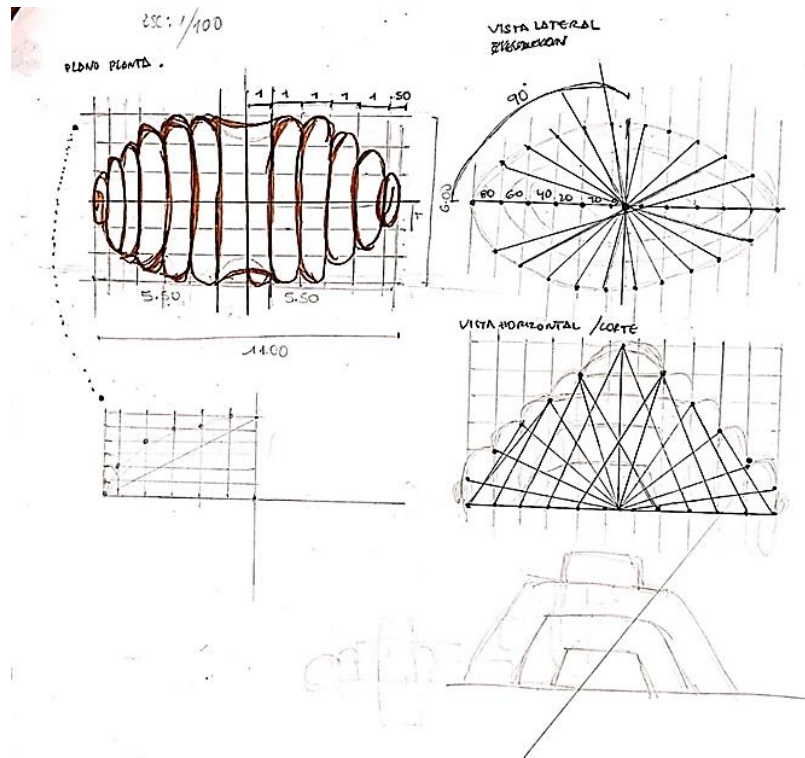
Dibujo a mano alzada de Croissant: cortes planta y elevaciones
